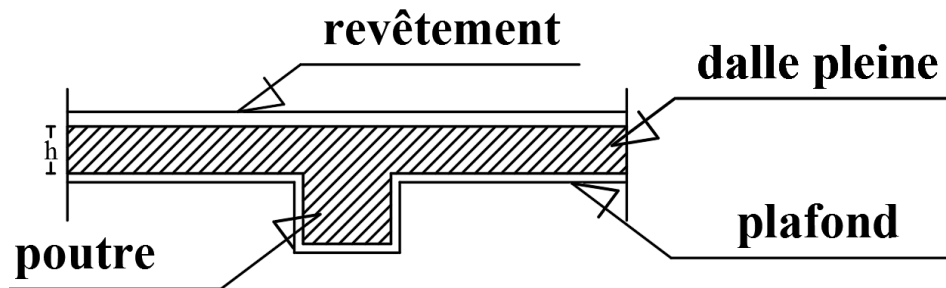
Eléments constituant un plancher en dalle pleine.
